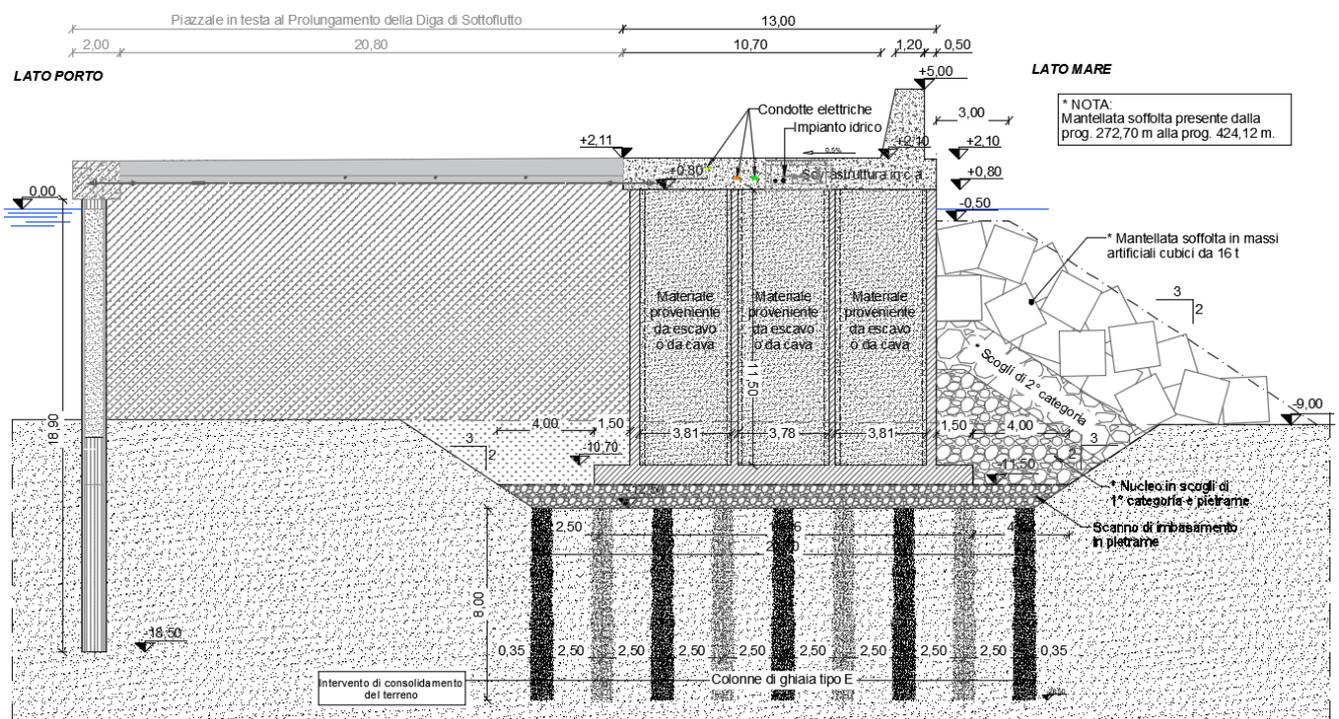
Cassone da n°12 a n°14 (piazzale in testa al Prolungamento della diga di sottoflutto): sezione tipo
